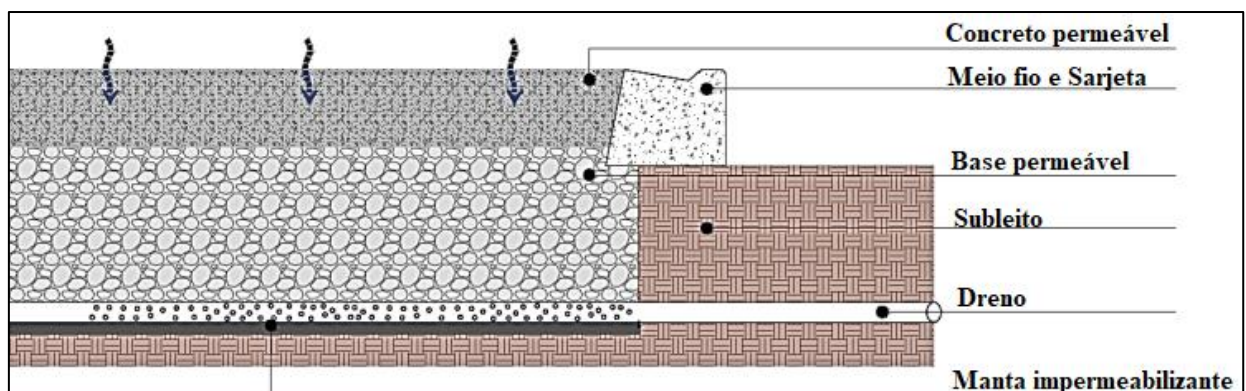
Projeto de Pavimento de Concreto Permeável com Infiltração Parcial
